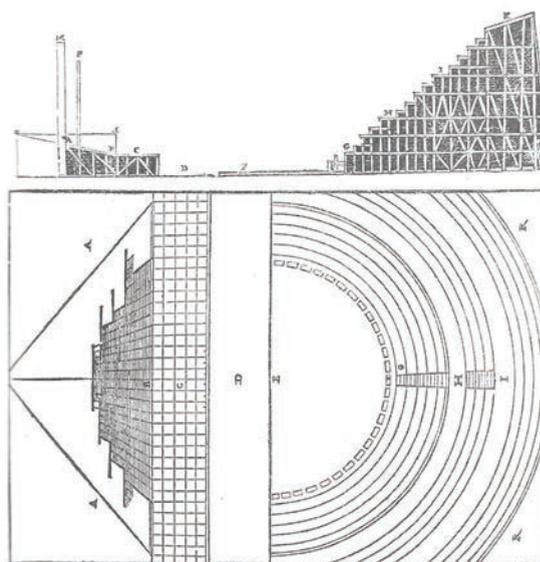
/ Progetto di allestimento teatrale, Serlio, *Il libro dell'Architettura*, 1545.
